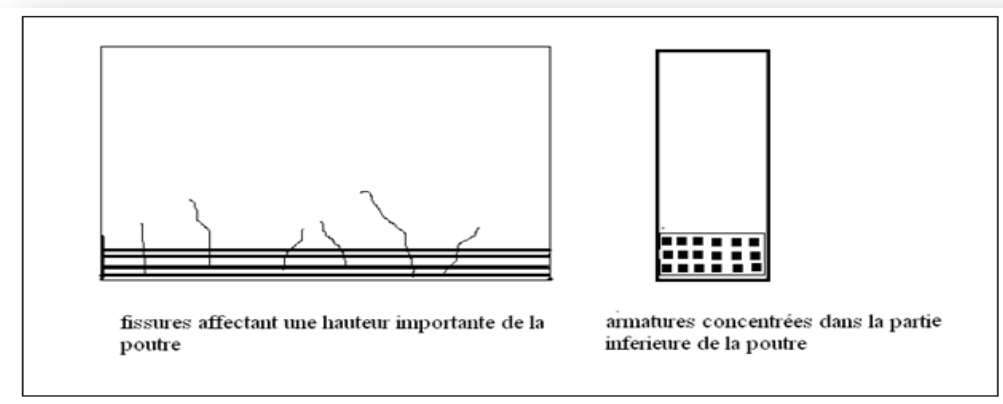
fissuration de la poutre de grande portée.
